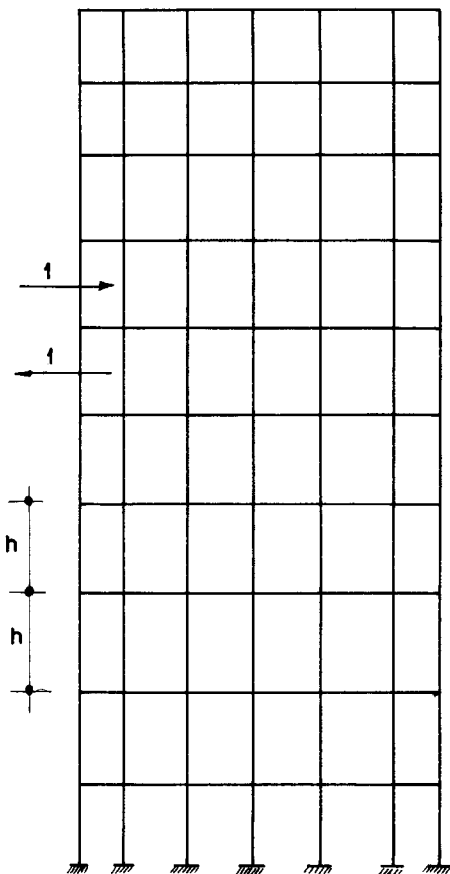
ESFORÇOS UNITÁRIOS NO EDIFÍCIO, PROVOCANDO APARECIMENTO DE \bar{M} NAS VIGAS E PILARES.
